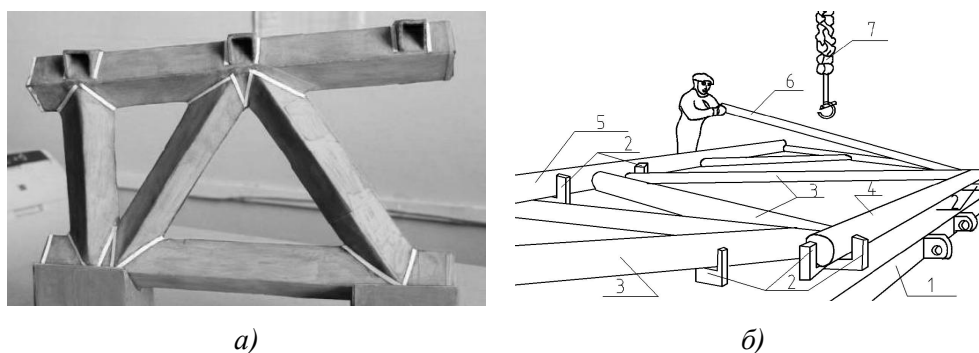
Снимок фрагмента фермы из трубчатых профилей квадратных сечений (а) и схема сборки конструкции из труб (б):
